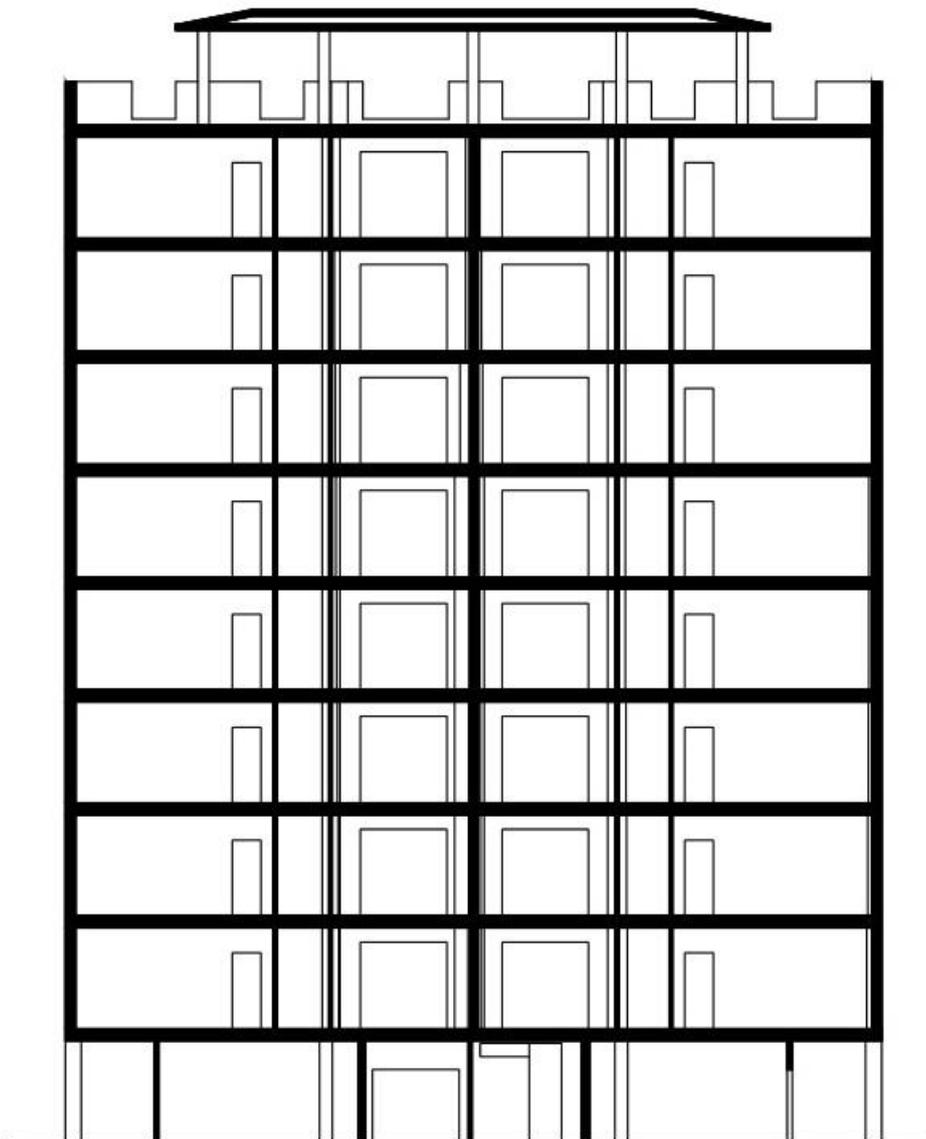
Sezione B-B, via Brofferio 1. Scala1:200. Fonte: Ater Padova.
